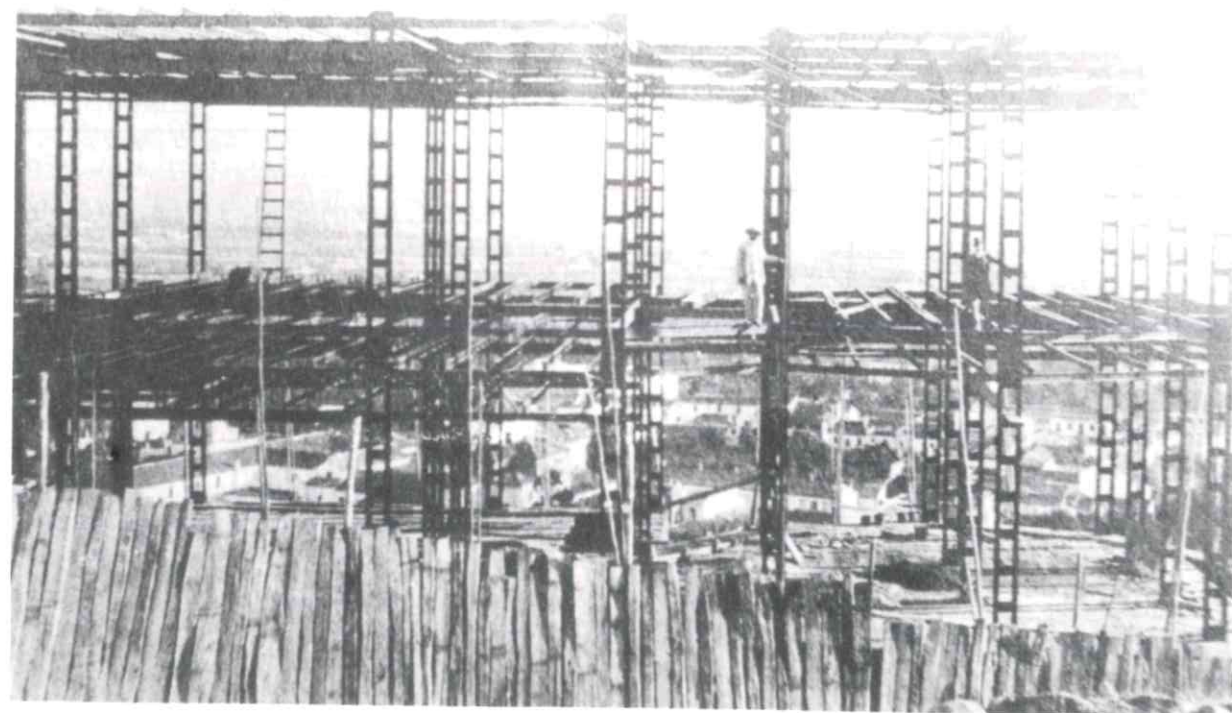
Estructura metálica del edificio a principios de 1908, terminada hasta suelo de planta 2ª.
